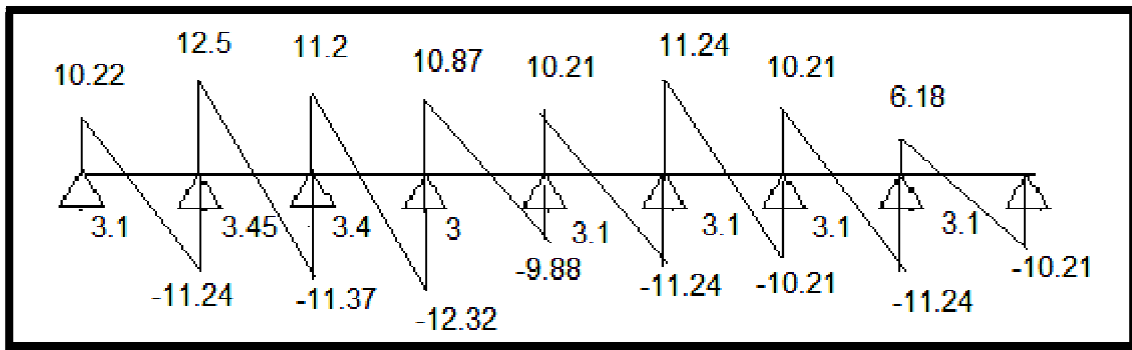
Diagramme des efforts tranchants à l'ELU des poutrelles du plancher Plancher terrasse (type 2)
